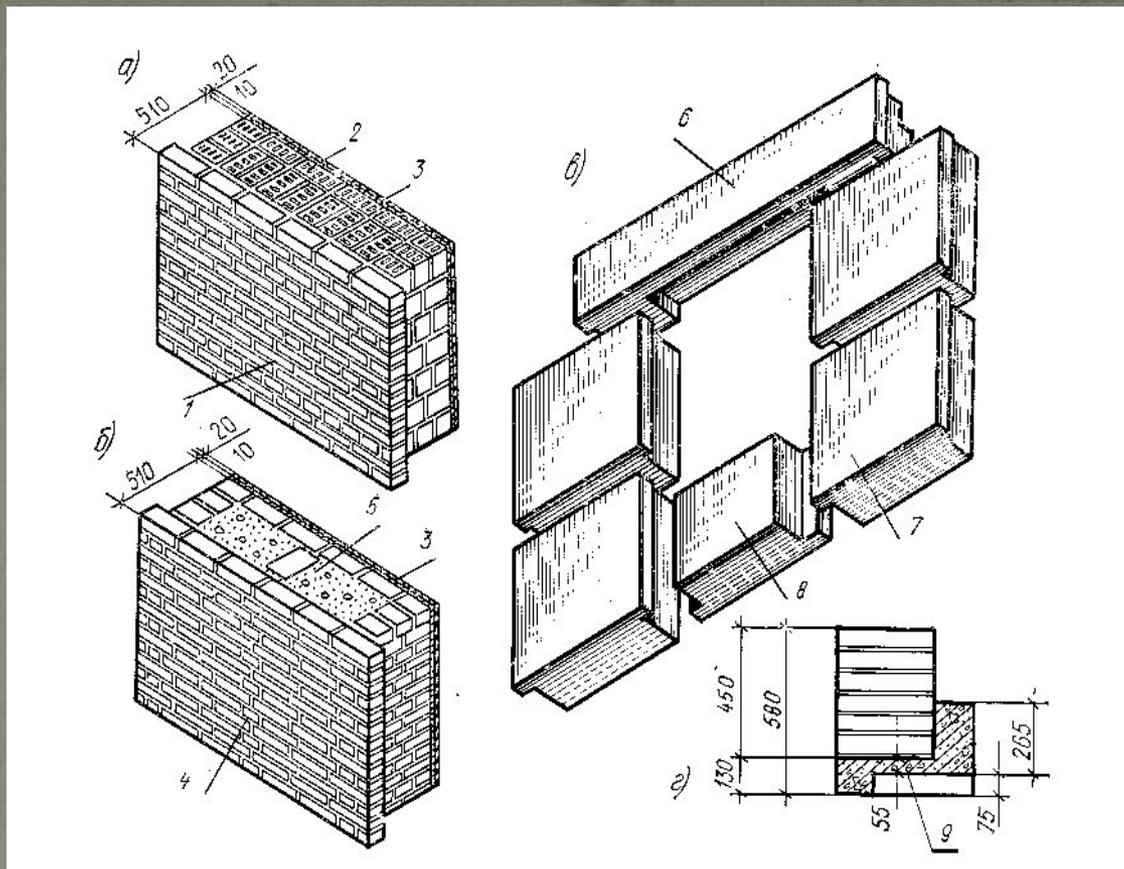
Стена из крупных блоков: а – блок из семищелевых камней; б- блок колодцевой кладки; в – трехрядная разрезка стен; г – перемычечный блок с железобетонной плитой; 1 и 2 – лицевой и семищелевой кирпичи; 3 – сухая штукатурка; 4 сплошной кирпич с расшивкой швов; 5 – шлакобетон; 6 – блок-перемычка; 7 – простеночный блок; 8 – подоконный блок; 9 – железобетонная плита.
